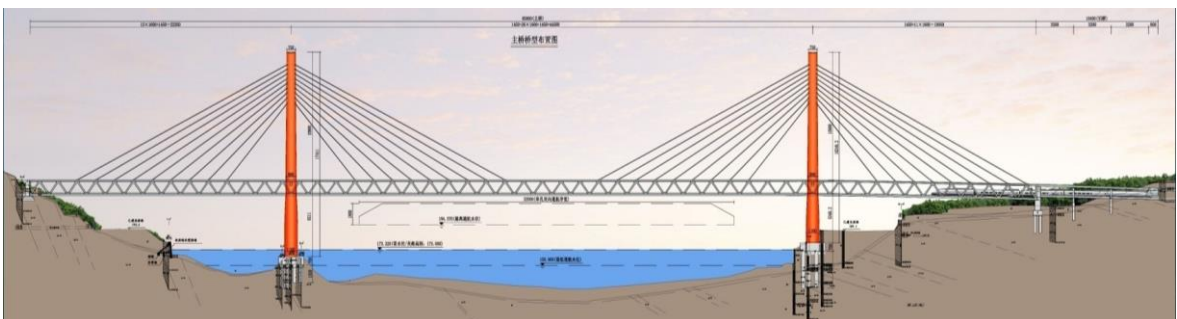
Alçado longitudinal da ponte Dongshuimen, China [85]
